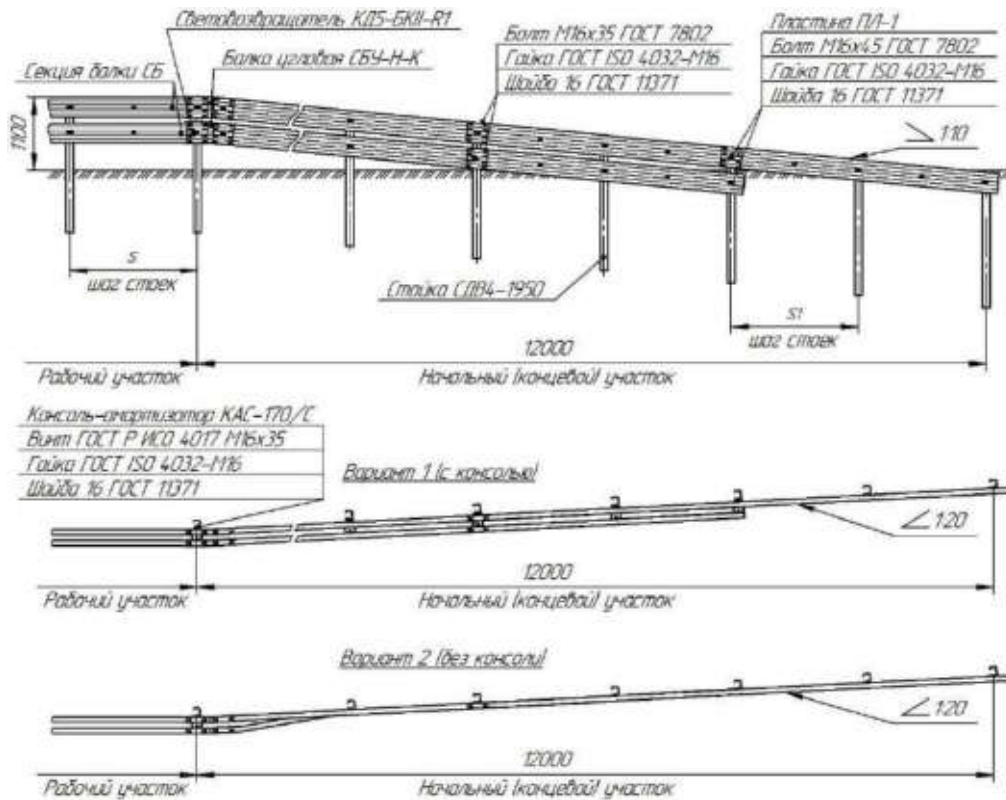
Схема сборки конструкции №17 (Изм. №1)
